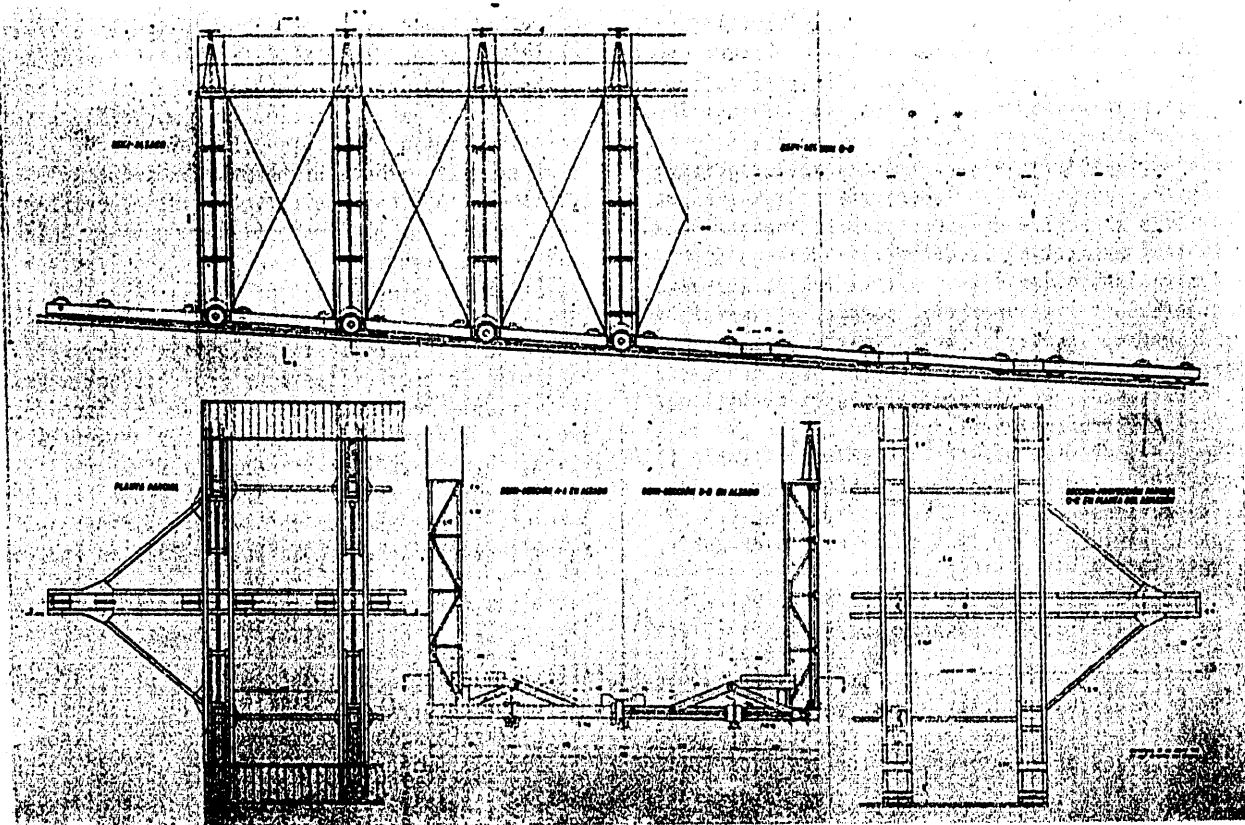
ª — Planta, alzado y sección transversal del carro.
